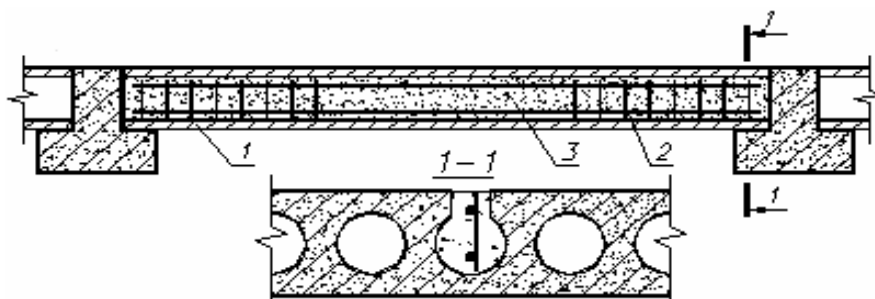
Усиление многопустотных панелей перекрытия установкой дополнительной арматуры: 1 – плита; 2 – сварной каркас; 3 – бетон
